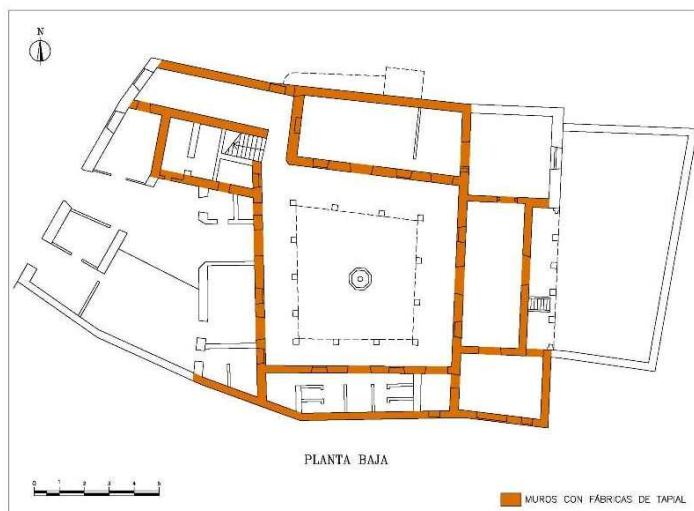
Casa de Calle San José 3. Planta baja. Muros constatados en tapial
